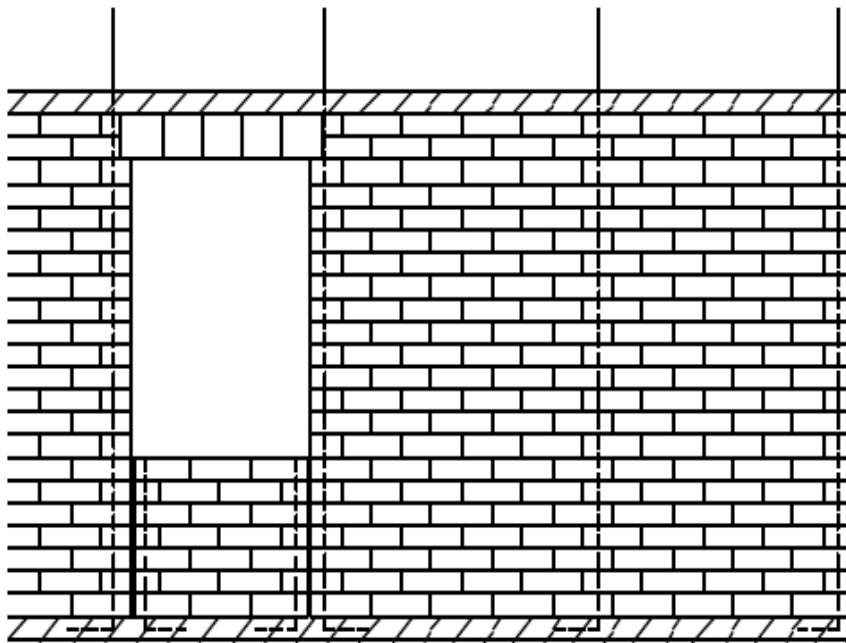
Mampostería reforzada. (Tomado de Oscar Javier Gutiérrez Junco. Mampostería estructural. 2003).
